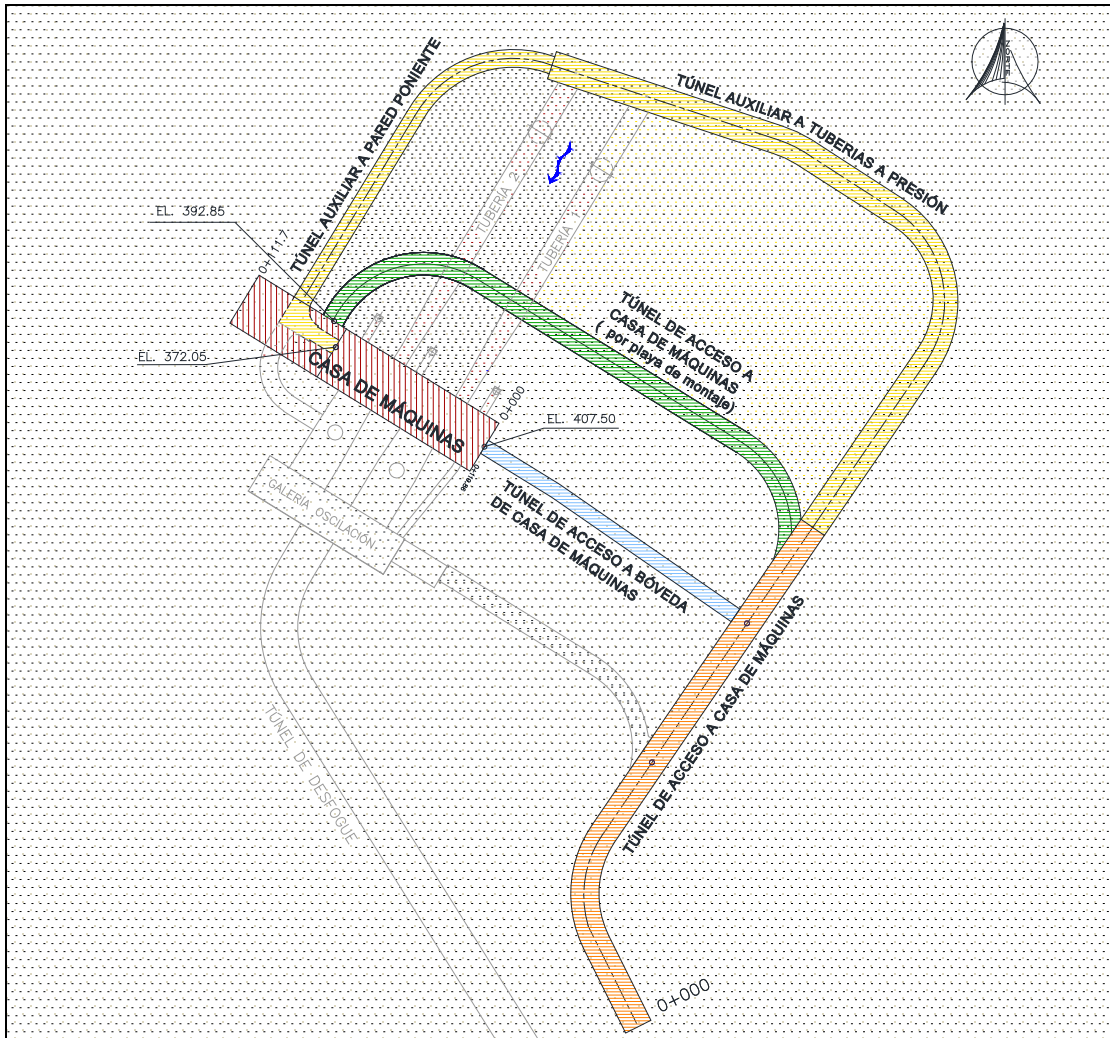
Vista en planta de los tres túneles de acceso a la Casa de Máquinas, utilizados para su construcción.
